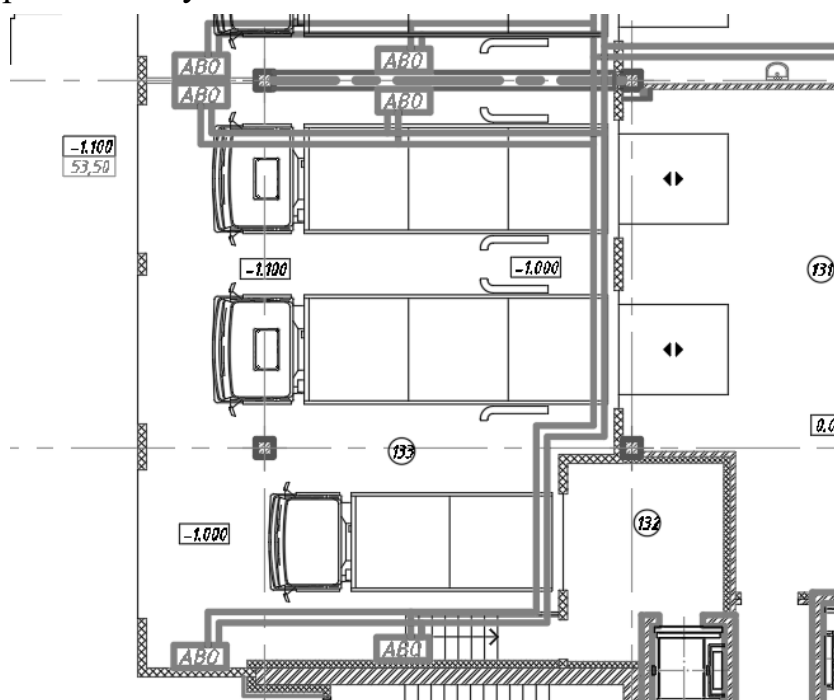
Схема установки агрегатов воздушного отопления.
